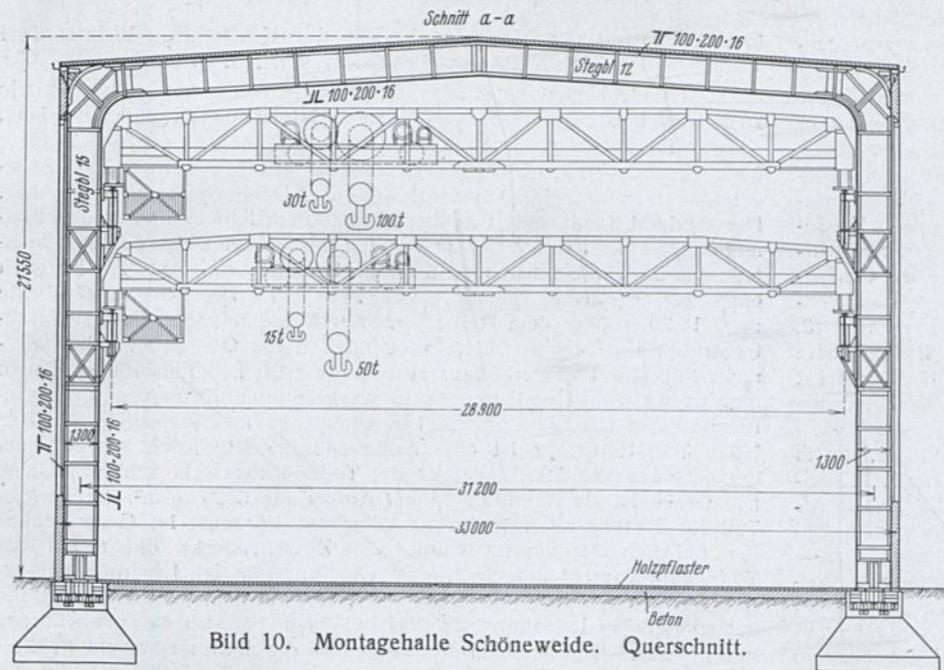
Montagehalle Schöneeweide. Querschnitt.
